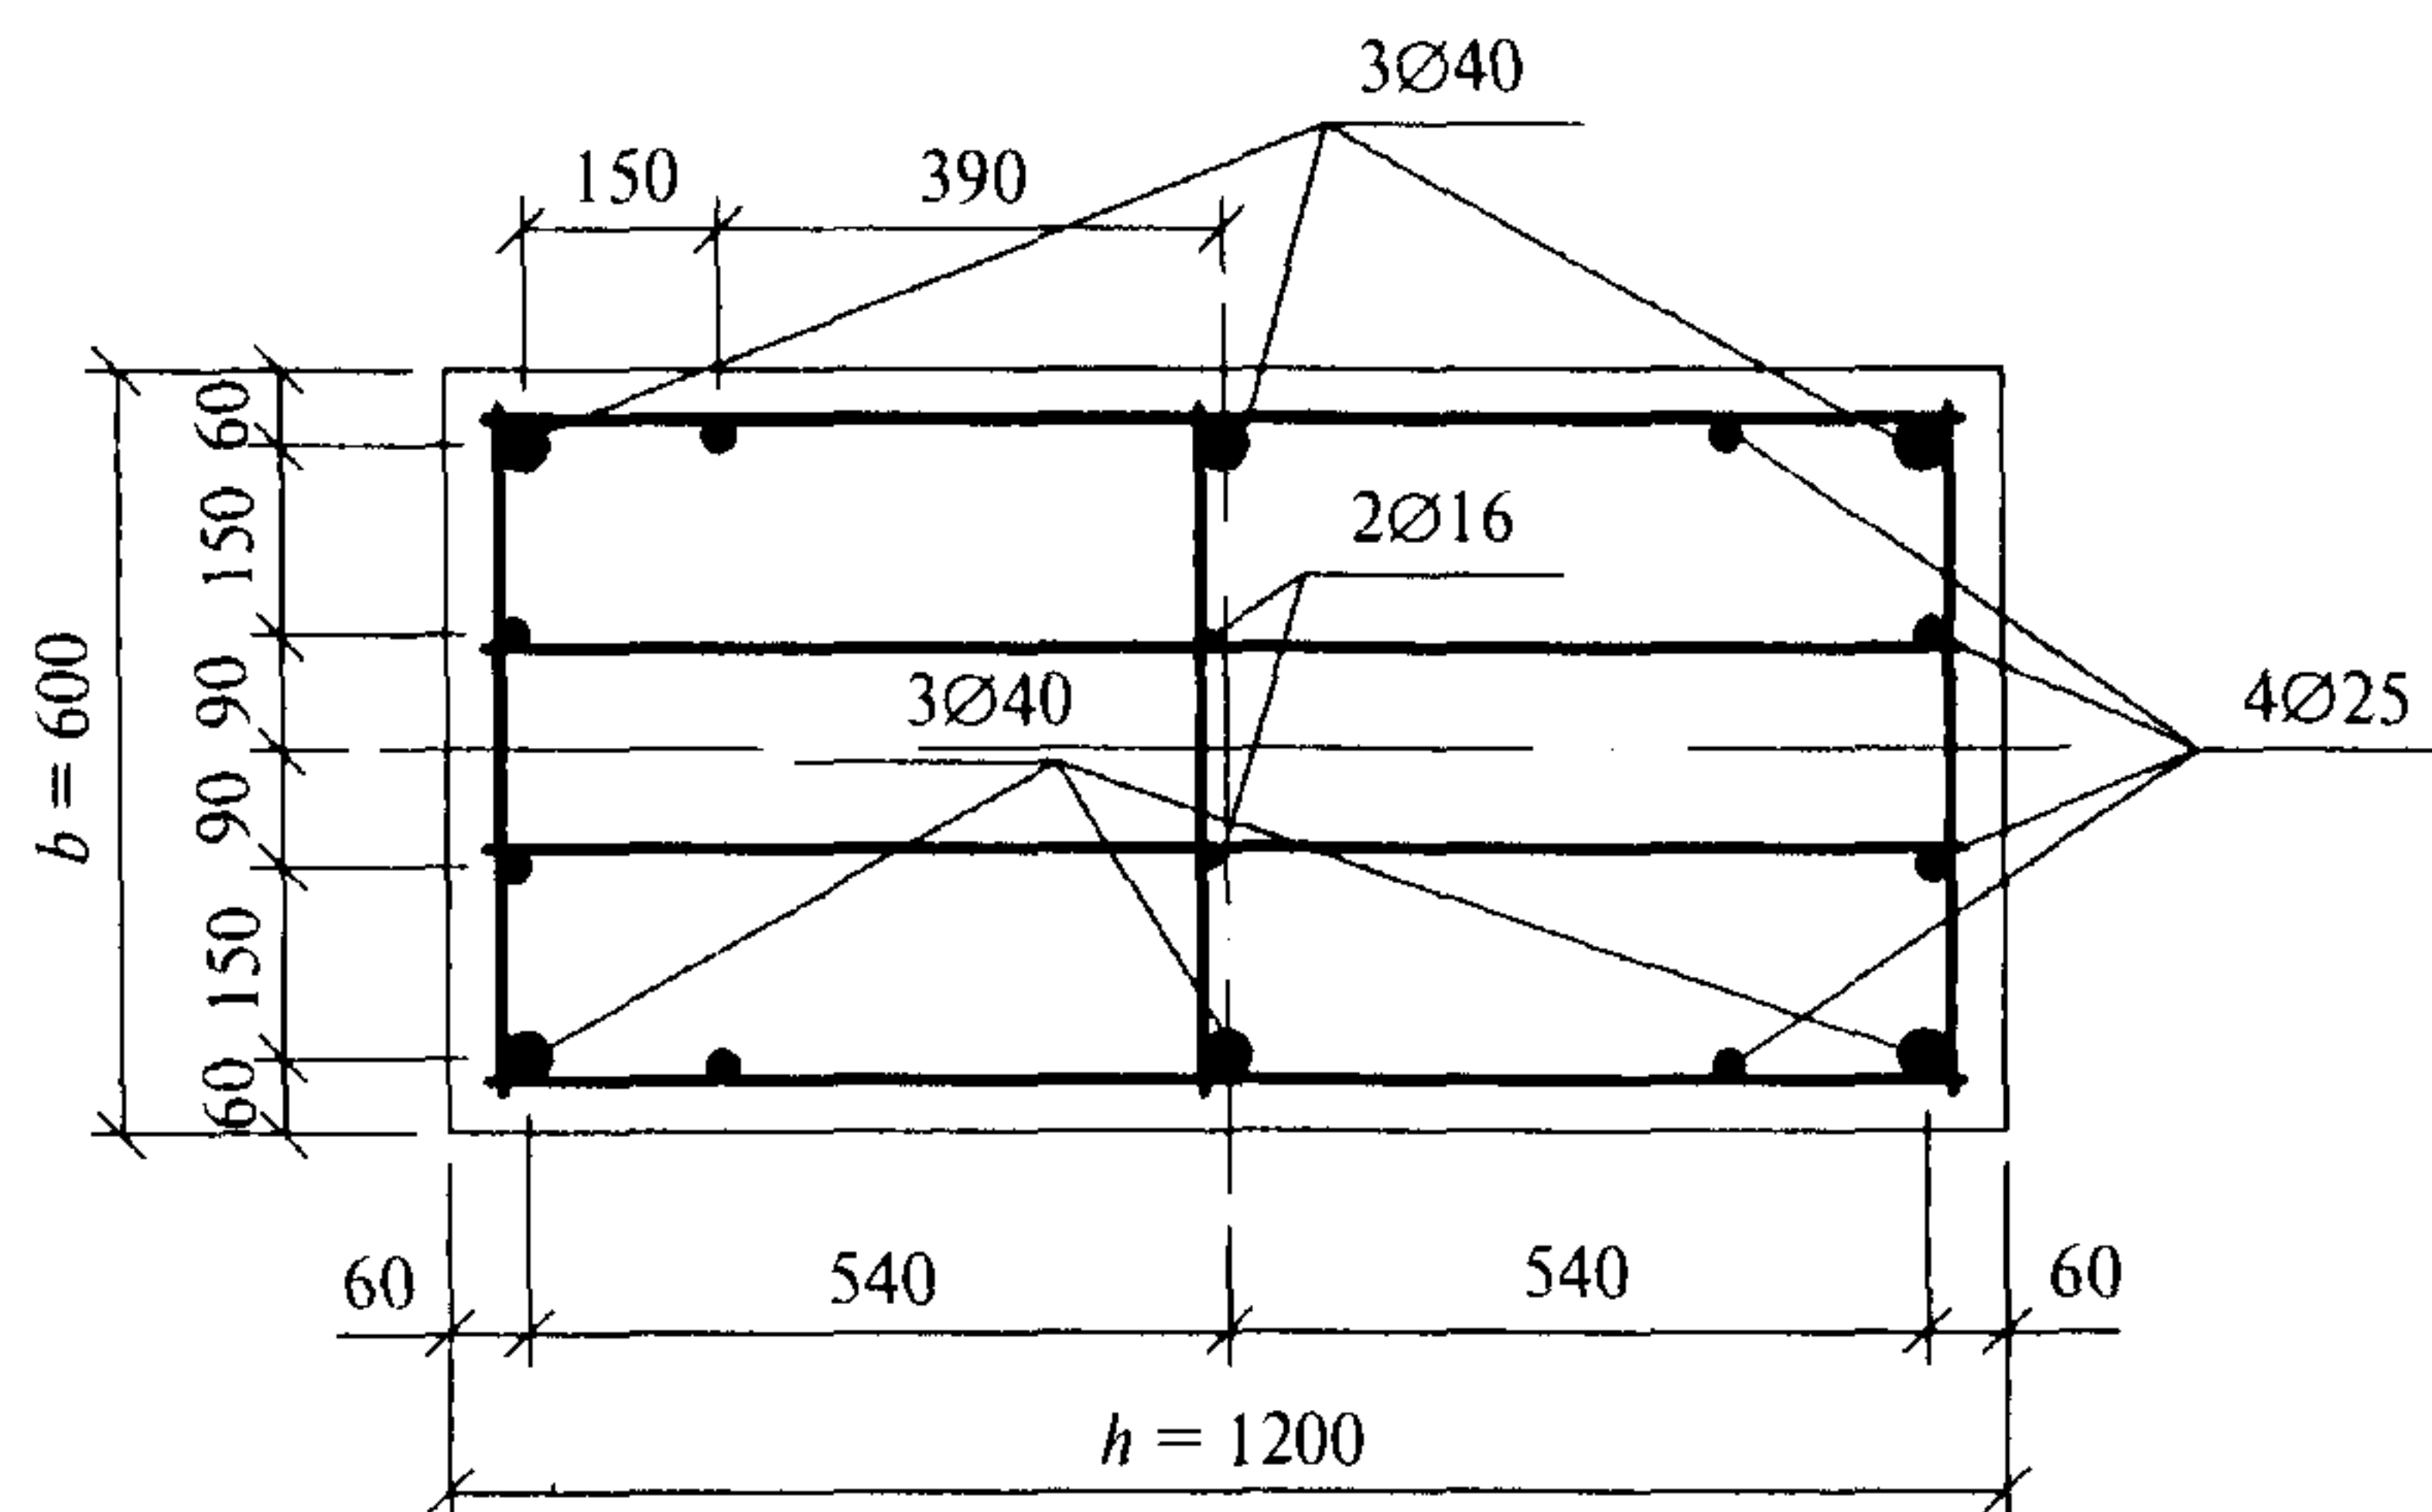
Поперечное сечение и армирование опорного кольца
